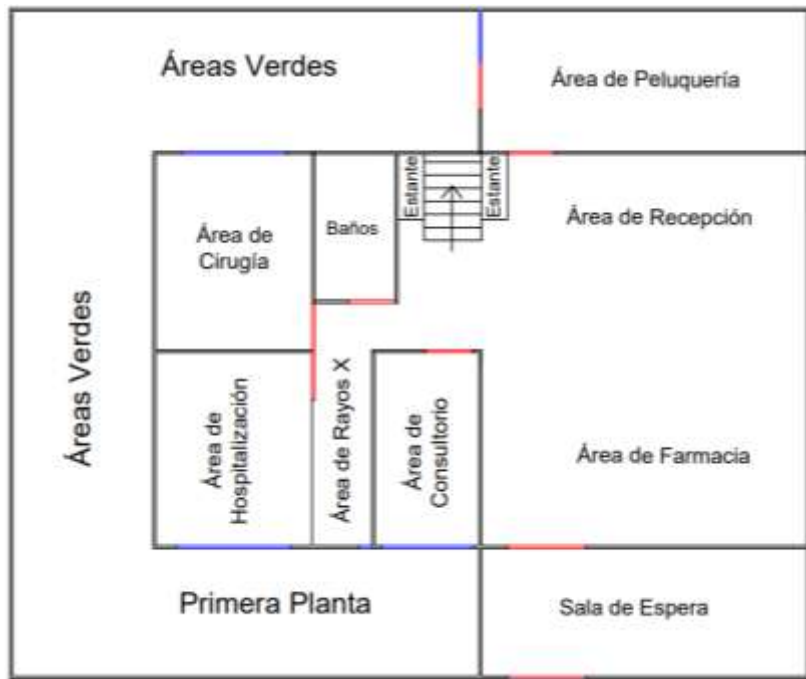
Layout primera planta clínica SIRA PETS, elaborado en AUTOCAD.
